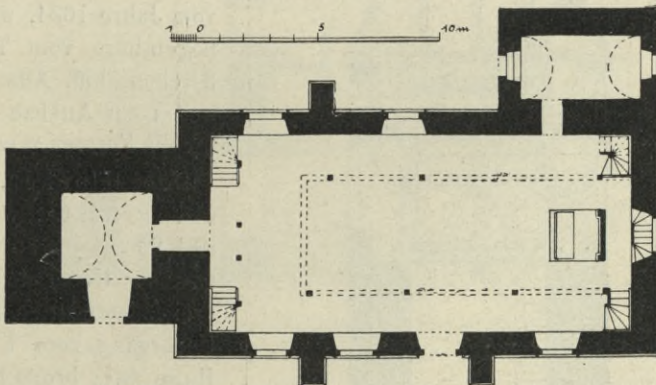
Weissig, Kirche, Grundriss. Zustand vor 1901.
